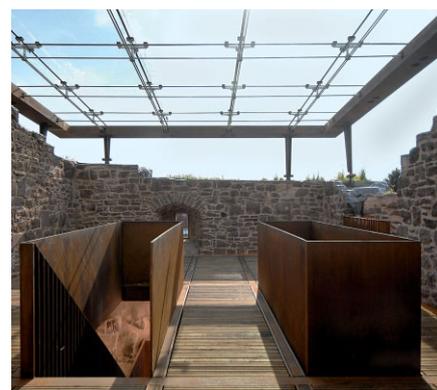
Vorgespannte Seilnetzkonstruktion mit umlaufendem, biegesteifen Randträger als horizontaler Abschluss des Turmmauerwerks (Foto: Dieter Leistner)
